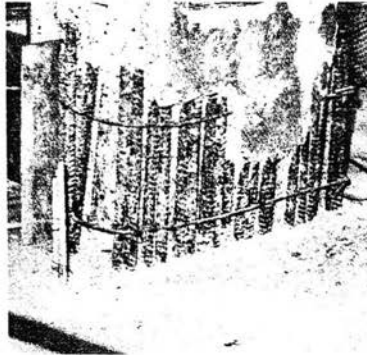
Acero de Refuerzo embebida en el Concreto dañada por Corrosión.
